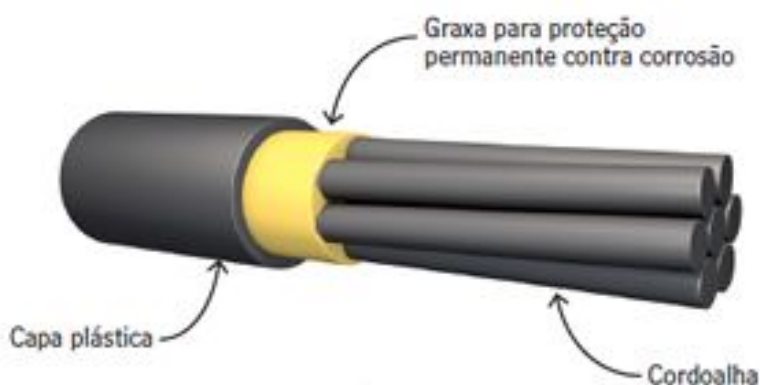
Monocordoalha engraxada. Fonte: Revista Técnica.
